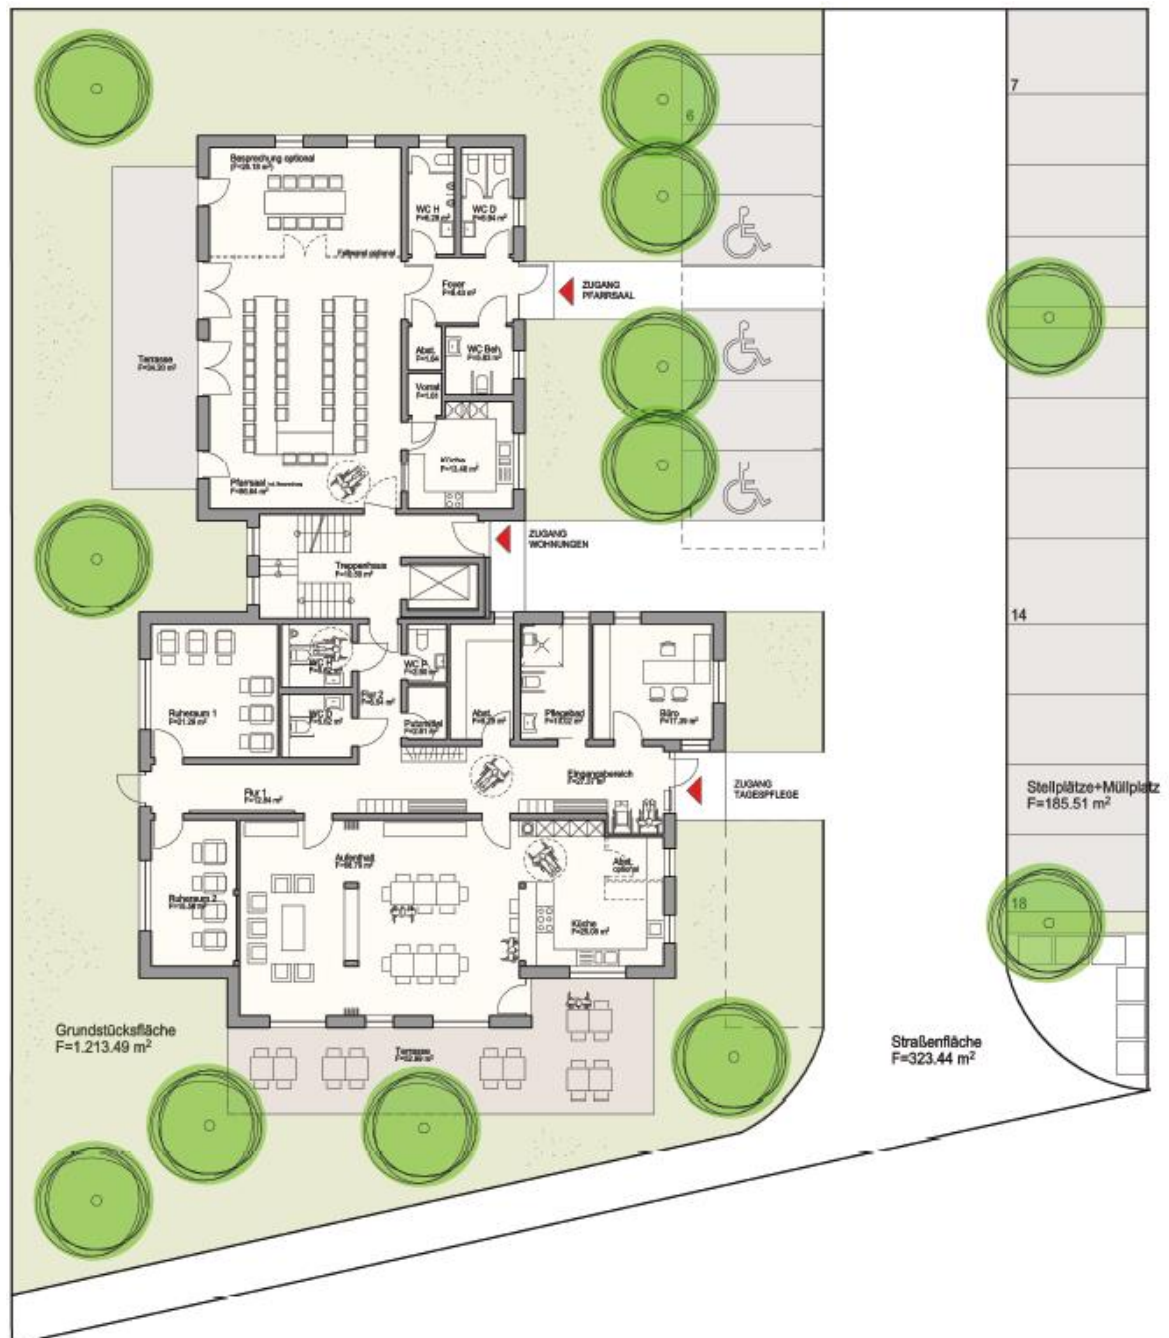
GSW Speyer GmbH, Grundriss Erdgeschoss, Stand 15.05.2024, freier Maßstab
